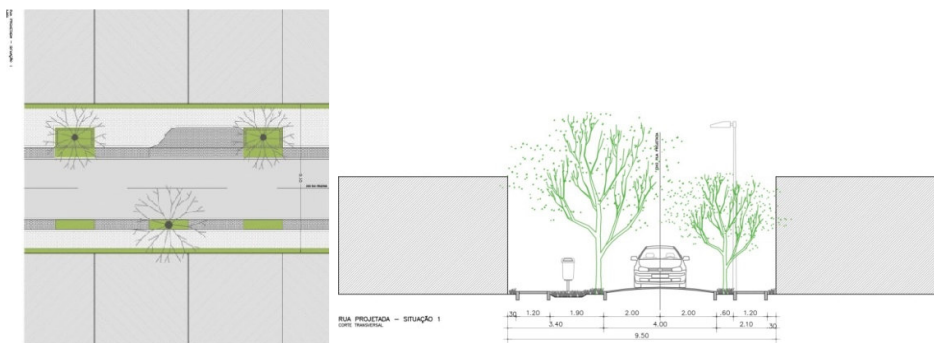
Planta da situação 1, eixo da via 10,00 m
